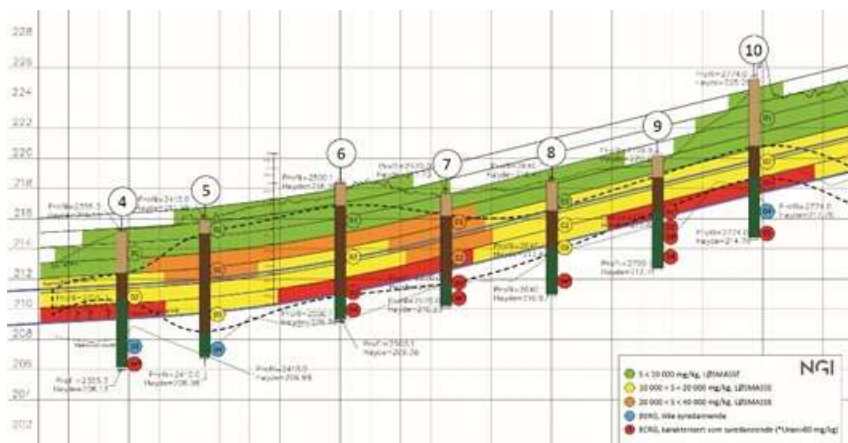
Skisse som viser massetyper i en skjæring med svartskifermasser
